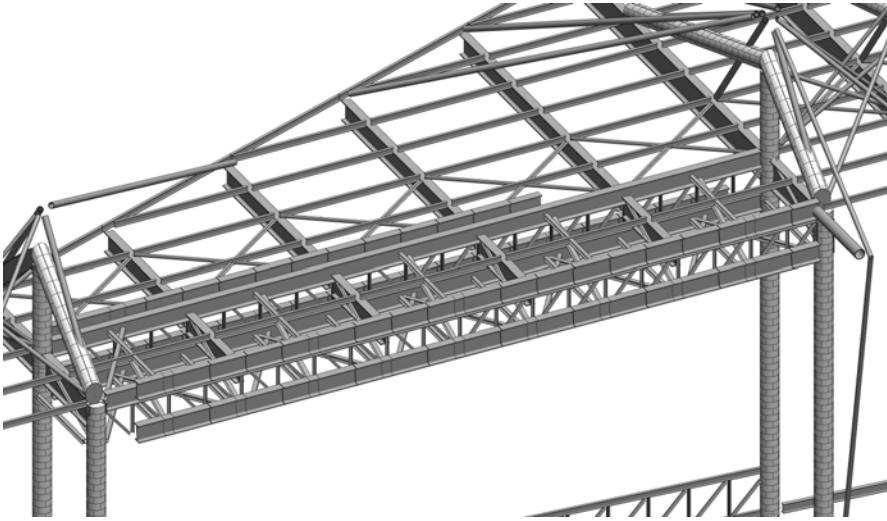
La trave reticolare a sbalzo aggiornata in Revit.
